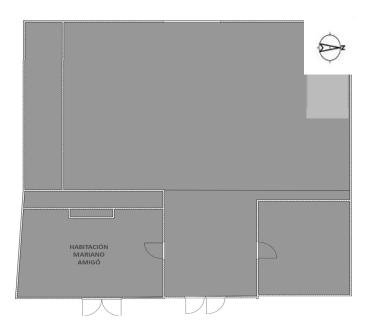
Plano planta baja: habitación "Mariano Amigó".
